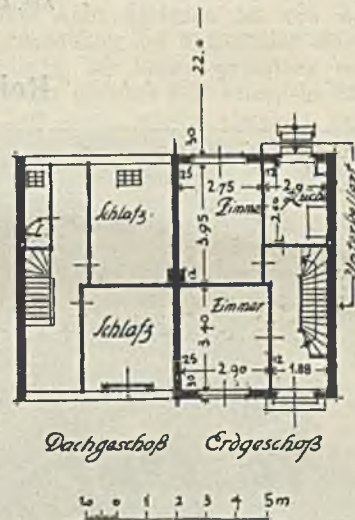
Reihenhäuser in der Achimerstraße zu Bremen
